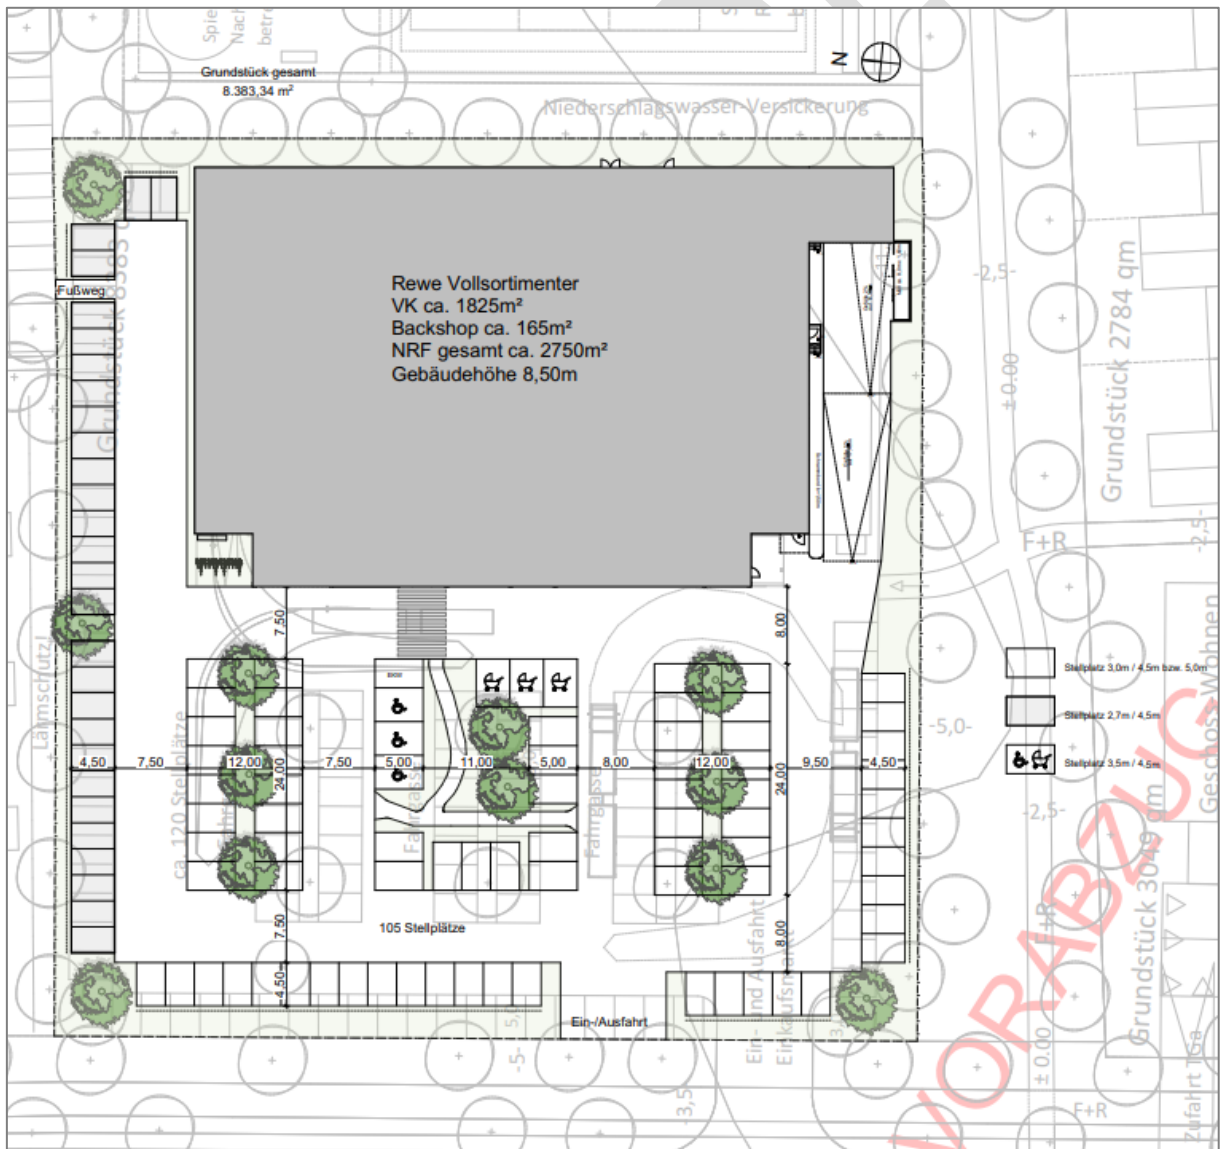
Vorhabenplan (o.M.) (RK-Next Architekten, 2023)
